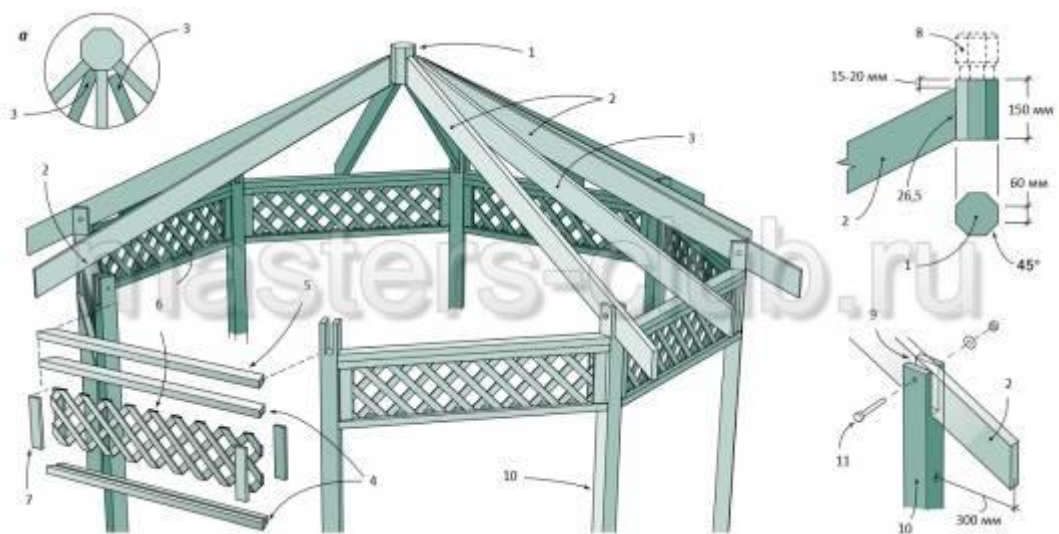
Стропильная система и карниз беседки: 1 — бабка подвесных стропил; 2 — стропила; 3 — промежуточные стропила; 4 — верхняя и нижняя перекладки карниза; 5 — верхняя накладка карниза; 6 — решетка из тонких реек; 7 — накладные планки; 8 — шпиль; 9 — паз под стропило; 10 — столб; 11 — болт с шайбой и гайкой.
